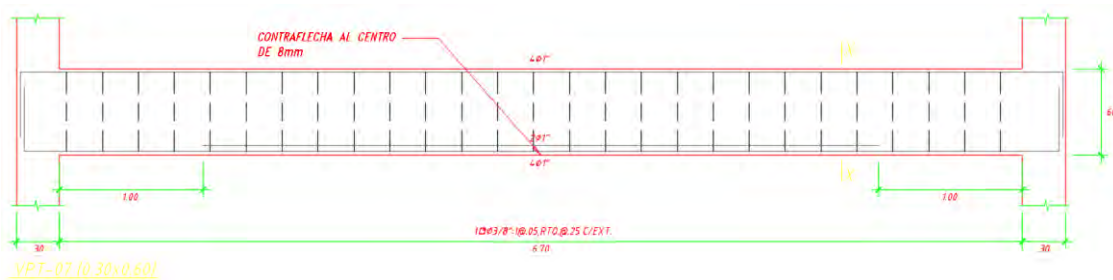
Vista en elevación del diseño de la Viga VPT-07
